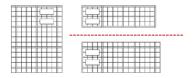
(h) Denah Pembalokan Lantai 6
